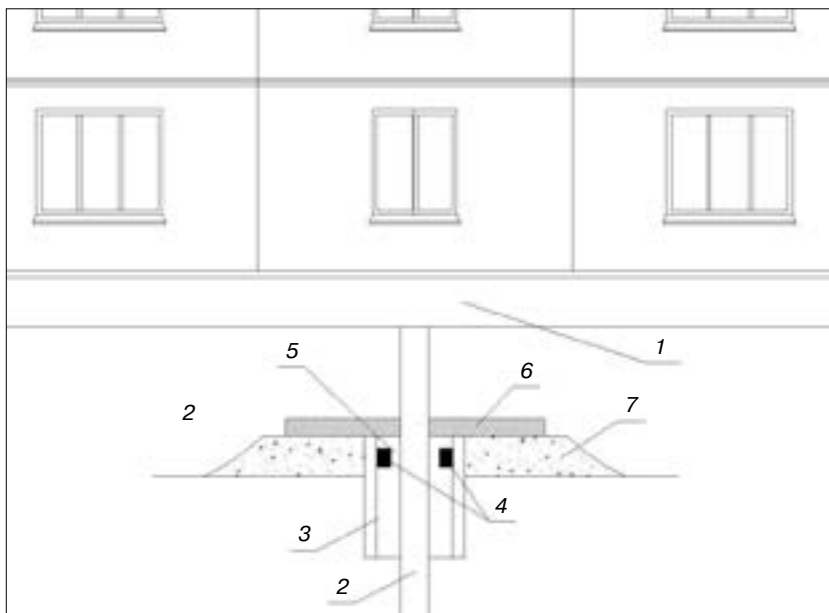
Сейсмостойкий свайный фундамент (вариант 1)
